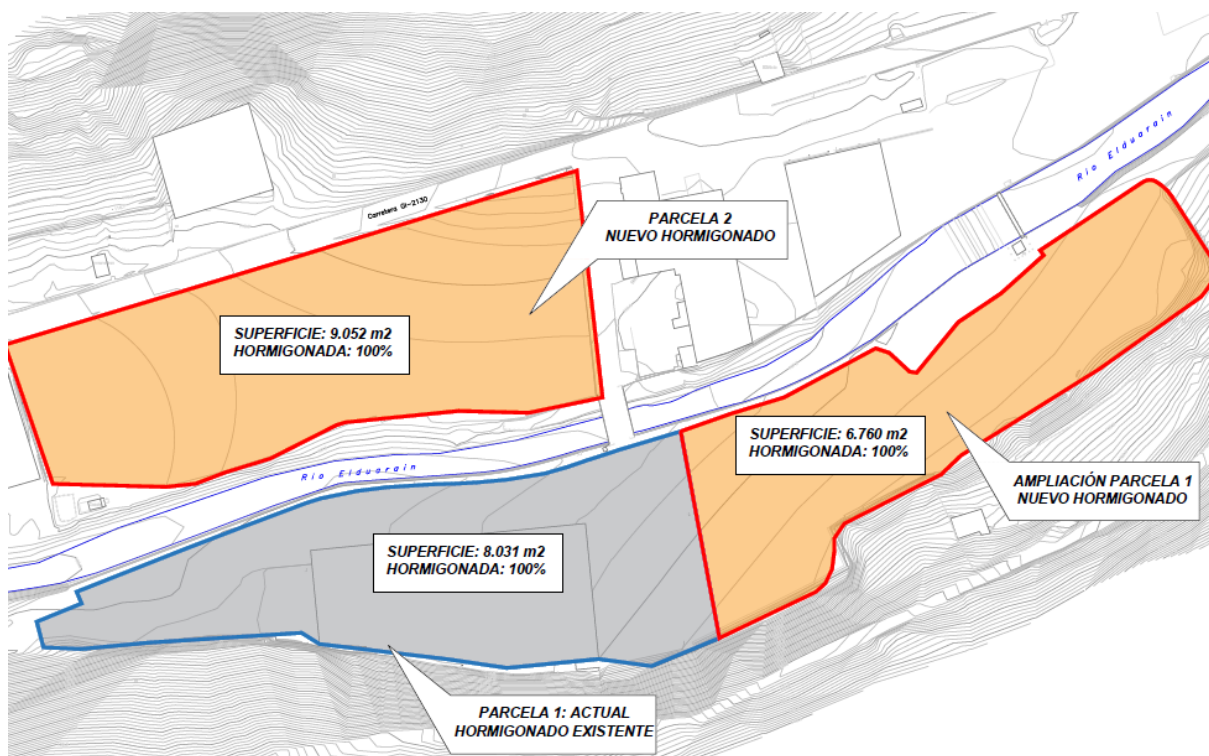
Distribución de las parcelas (hormigonadas y no hormigonadas)
